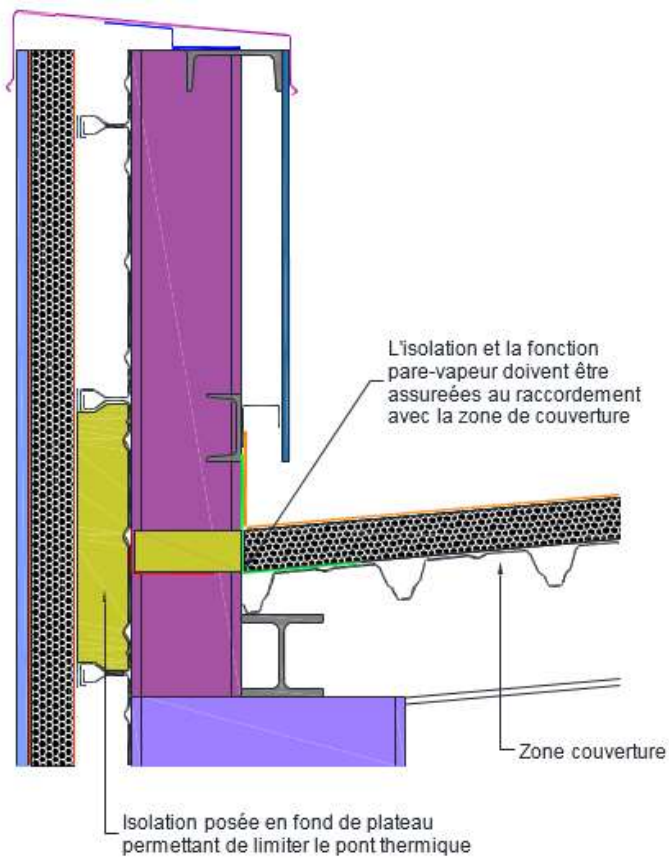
Coupe sur bardage triple peau en partie haute et raccordement avec la partie couverture (plateaux horizontaux)
